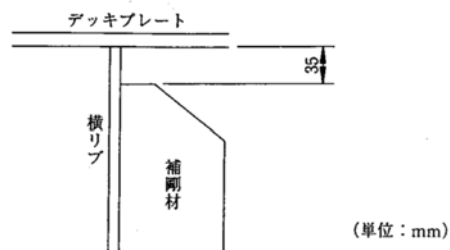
横リブ又は横桁の垂直補剛材の取付構造の標準
